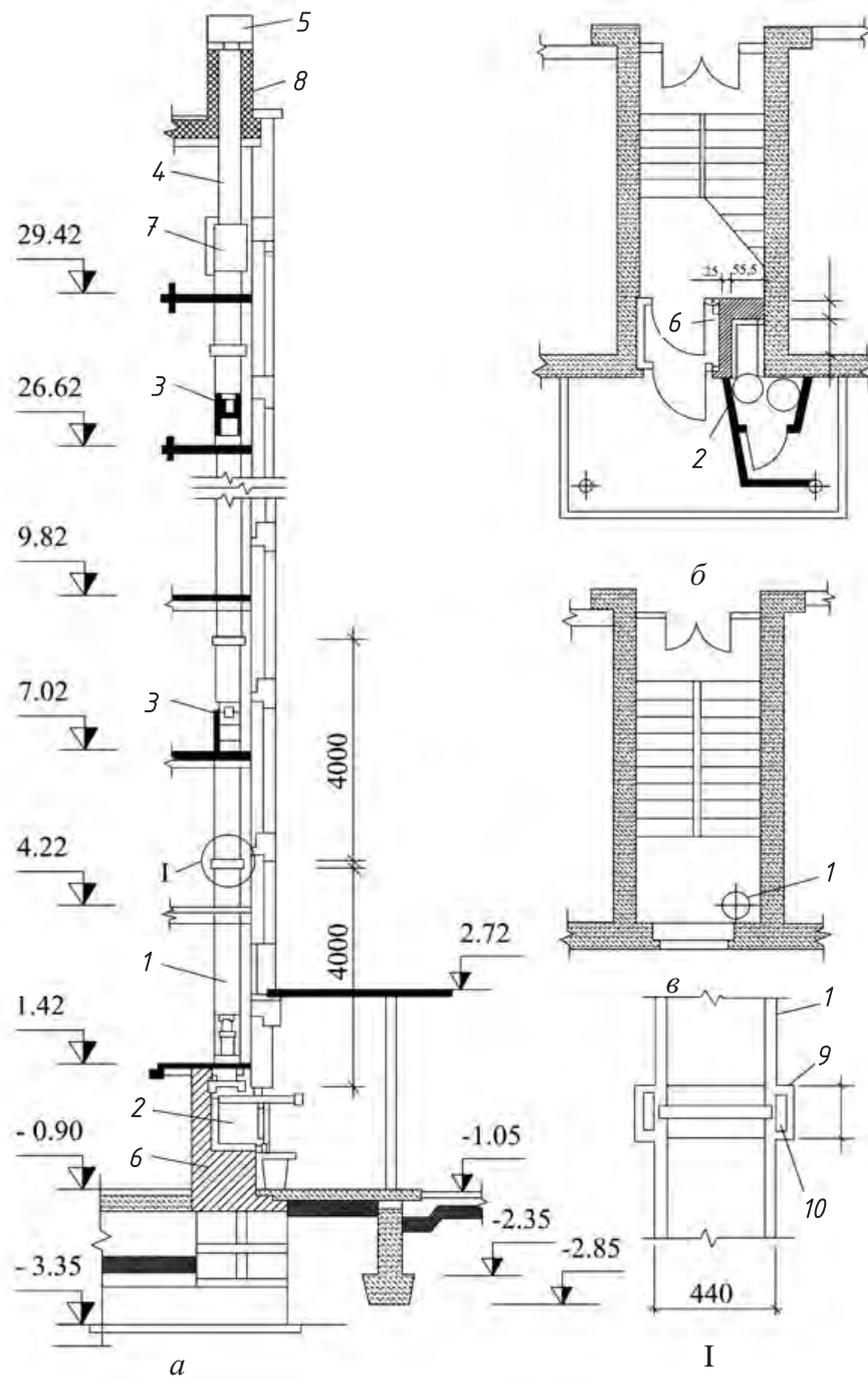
Расположение мусоропровода в лестничной клетке жилого дома: *a* — разрез; *б* — план первого этажа; *в* — то же, типового: I — стык асбестоцементных труб мусоропровода: 1 — асбестоцементная труба; 2 — бункер; 3 — приемный клапан; 4 — вентиляционная труба; 5 — дефлектор; 6 — кирпичная кладка; 7 — короб для прочистки; 8 — утеплитель; 9 — асбестоцементная муфта; 10 — конопатка и чеканка
